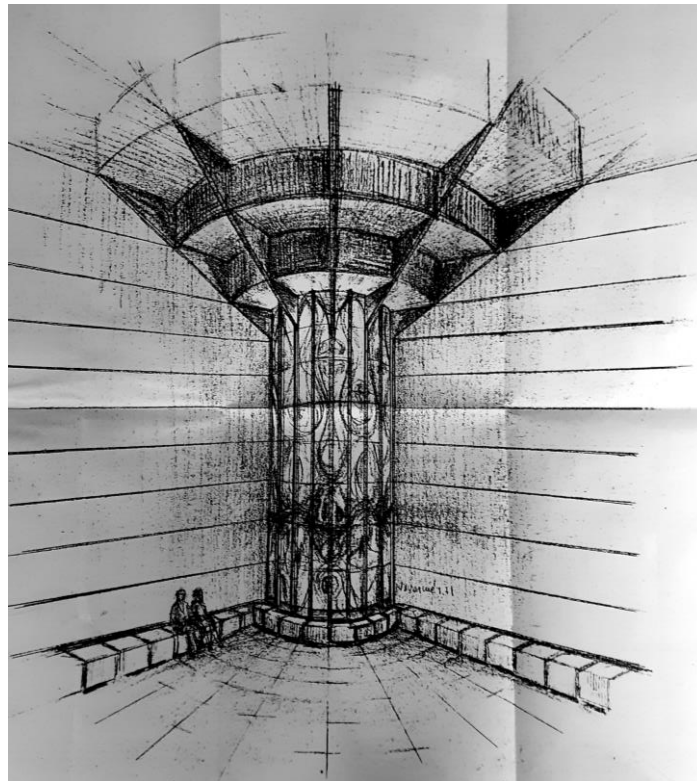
Vidriera del vestíbulo situado en la primera planta del anfiteatro (Fuente: Archivo General de la Administración)
